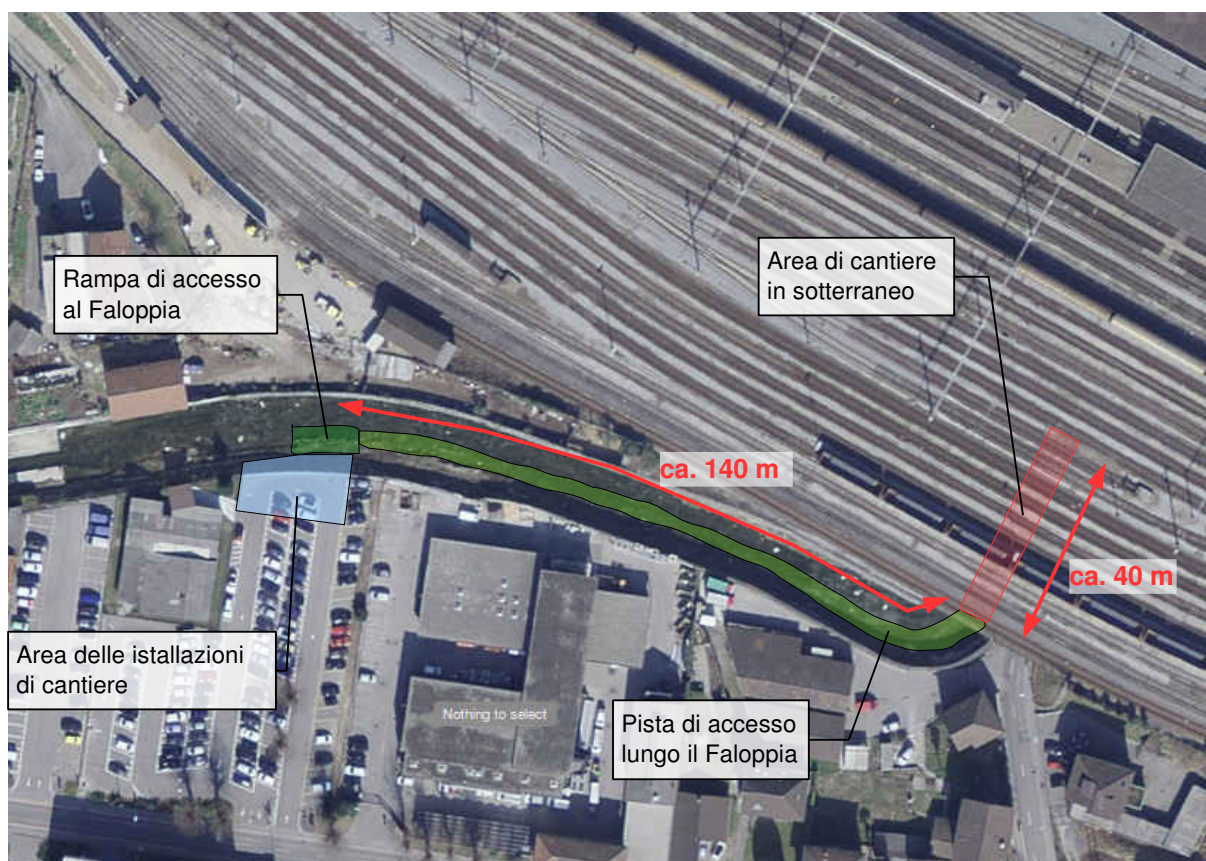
Area di cantiere, accesso e area delle installazioni sul Faloppia.
